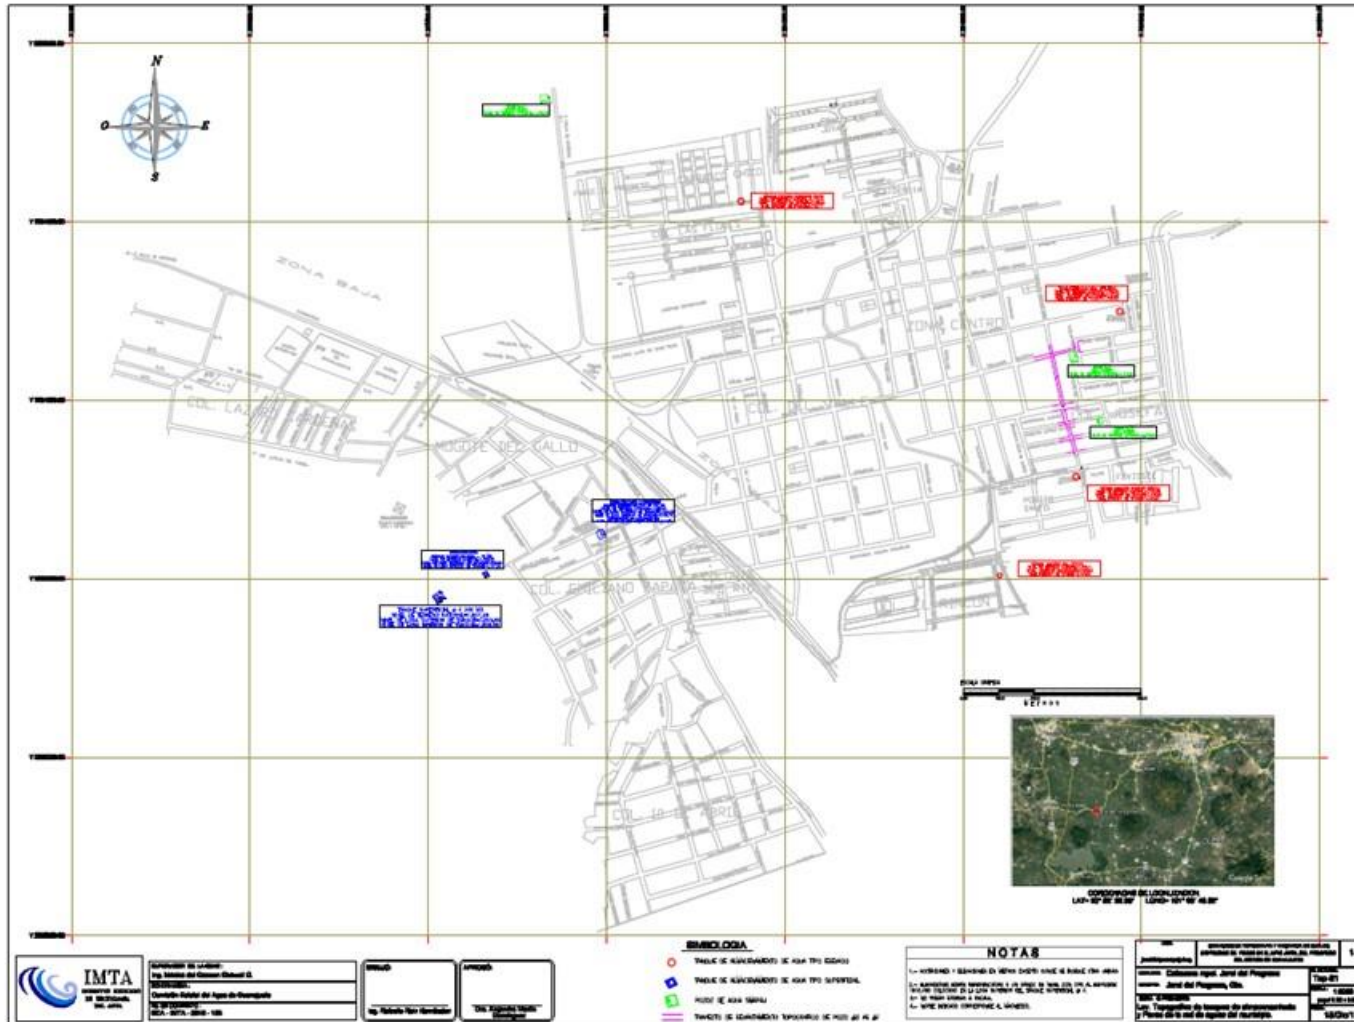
Plano general de localización (Ver anexo de planos para más detalle)
